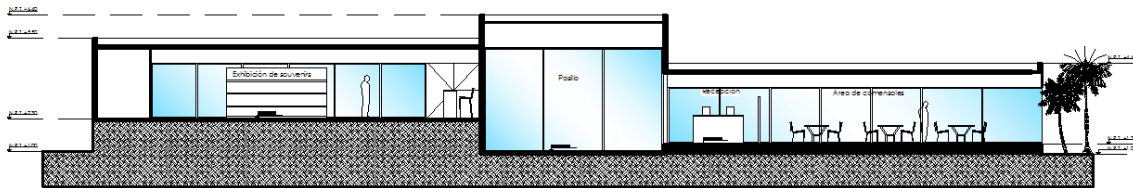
Anteproyecto fachadas. Autoría: Propia
